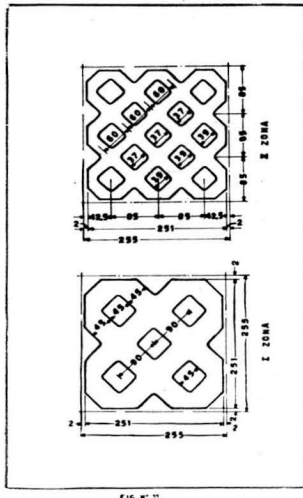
Tipos de tijolos com que serão constituídas as zonas de empilhamento dos cowpers em construção.
